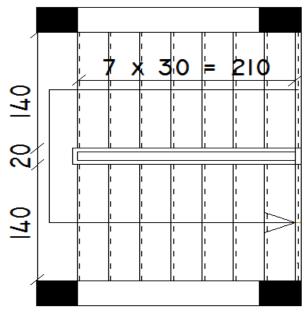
Vue en plan d'un escalier droit à deux volées.
